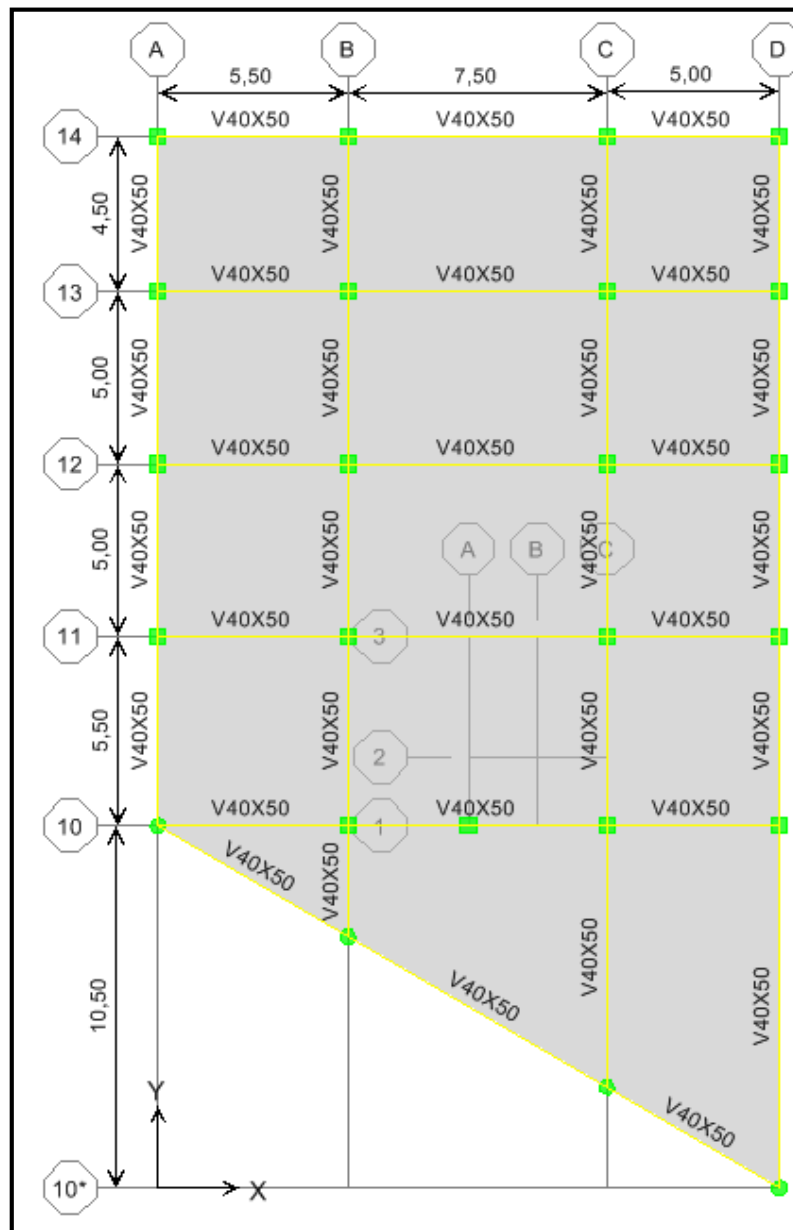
Secciones Finales de Vigas (Nivel TECHO)
